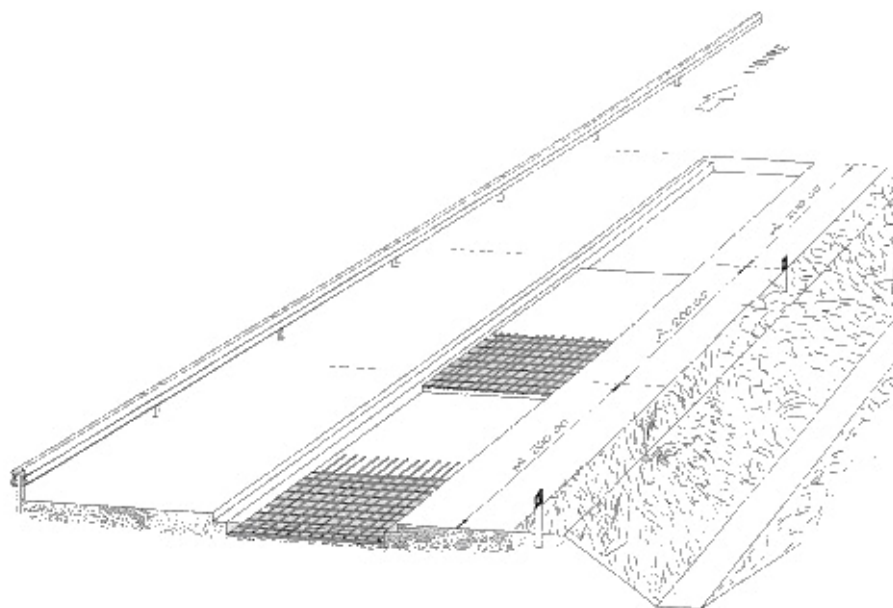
Prospetto della pavimentazione rinforzata sull'autostrada A4 Palmanova-Udine (Autovie Venete S.p.A.)
